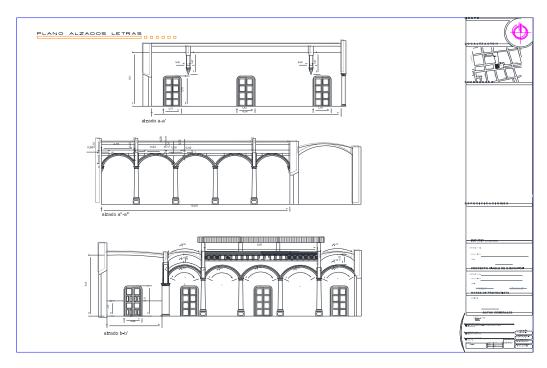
Plano Alzados. Eloísa Galván González. 2016.
